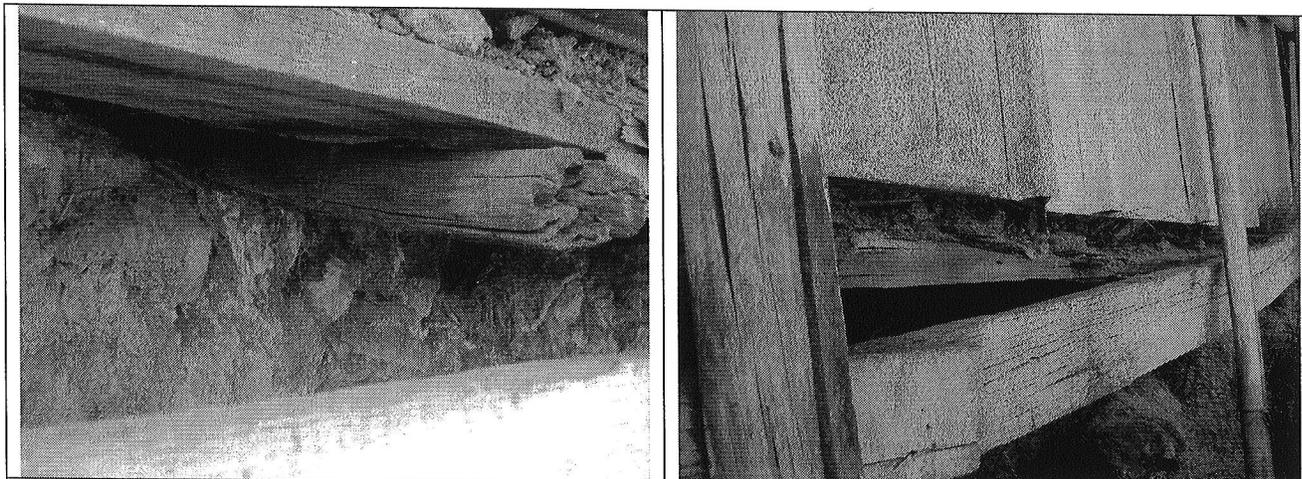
, 6 y 7. Extensión de la grieta al muro de piedra pegada que confina el terreno de cimentación, muro sobre el cual se observó una grieta de aproximadamente 0.50 cm de abertura de tendencia diagonal que se extiende unos 50 cm y luego se extiende de manera horizontal con la misma abertura a lo largo de 1.50 m aproximadamente, en la Unidad Habitacional identificada como Lote B.
